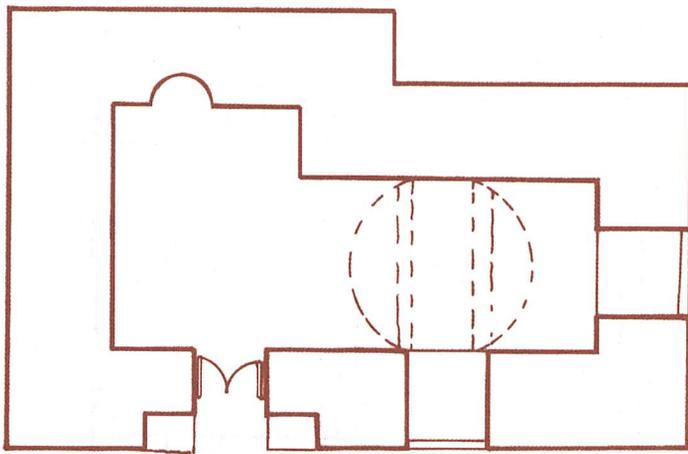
المسقط الأفقى لمسجد الشيخ قنديل برشيد
